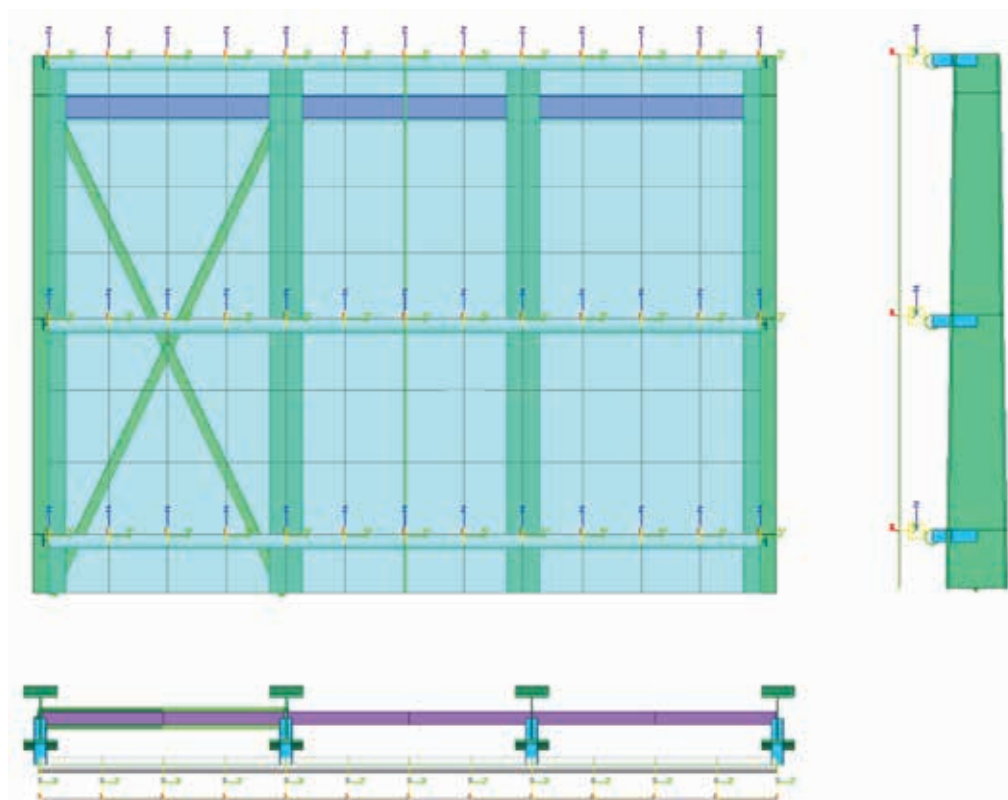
| Pianta, prospetto e sezione della facciata vetrata implementata in Midas Gen.
